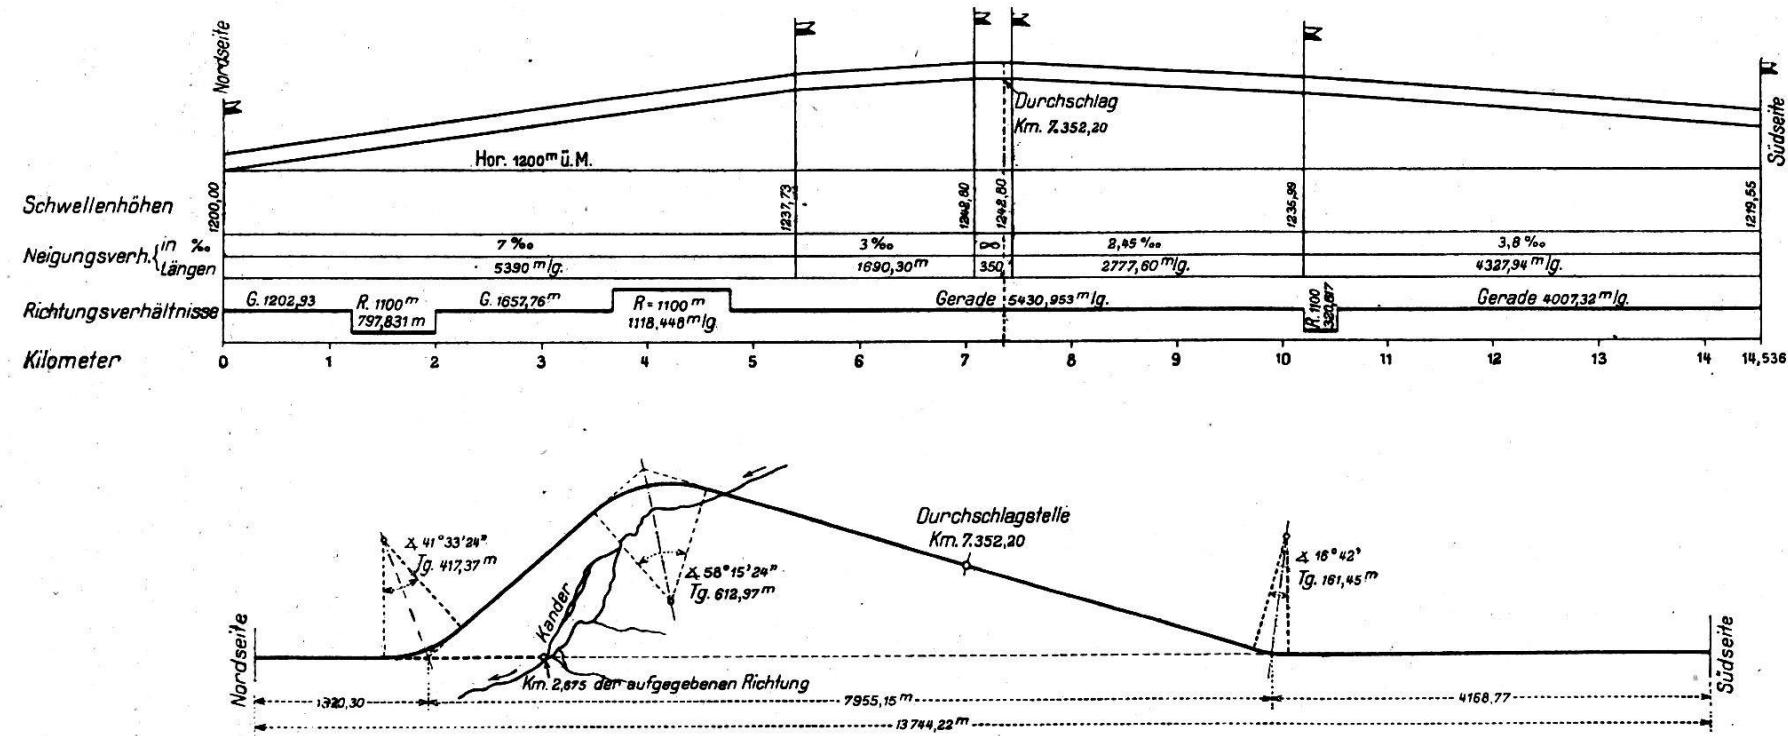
Profil en long et situation du tunnel du Lötschberg. Longueur 1:100,000.
